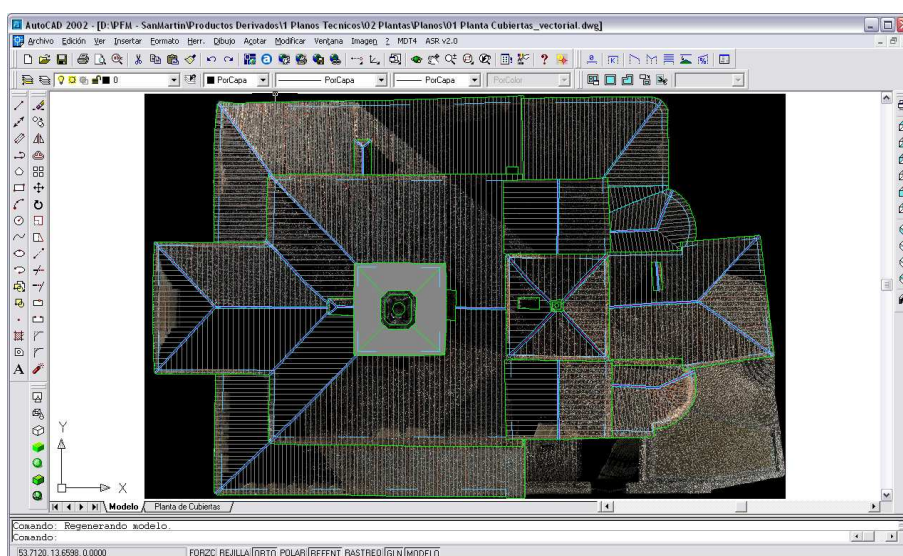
la vectorización de las líneas de las cubiertas sobre la ortoimagen, en AutoCad
